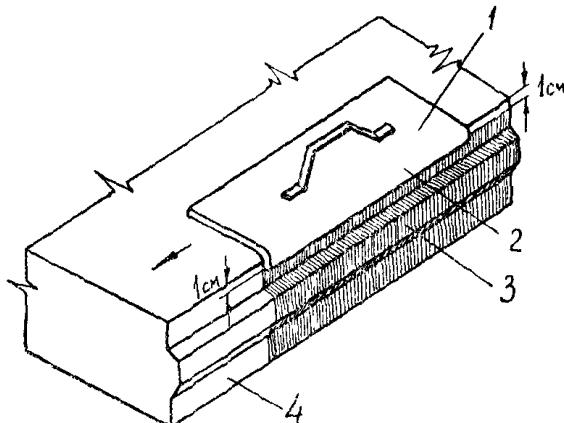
Шаблон для предотвращения попадания разжиженного битума или мастики на кромку бетонного покрытия
